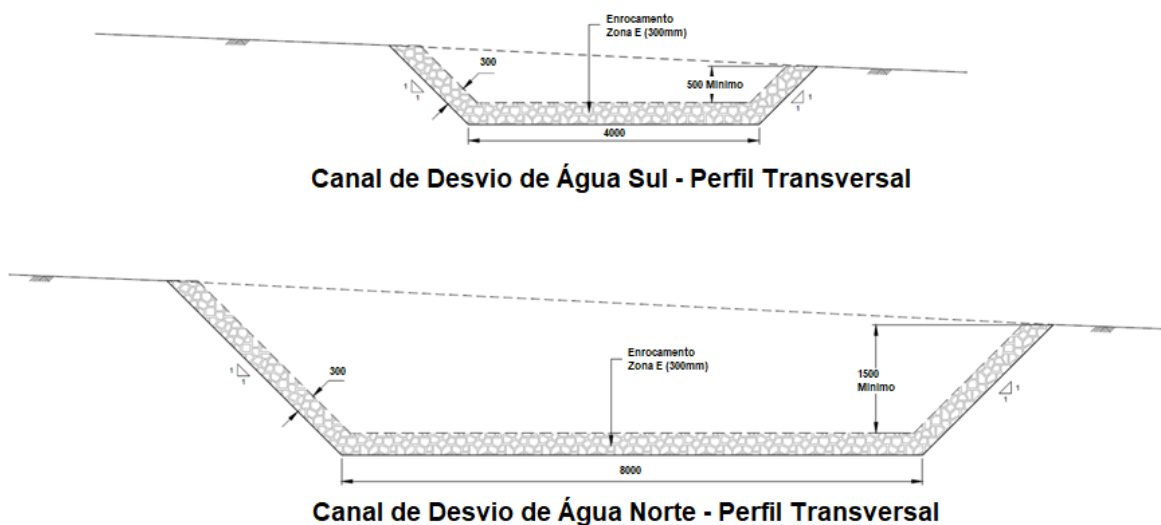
Secção transversal tipo da construção de um canal de desvio.
